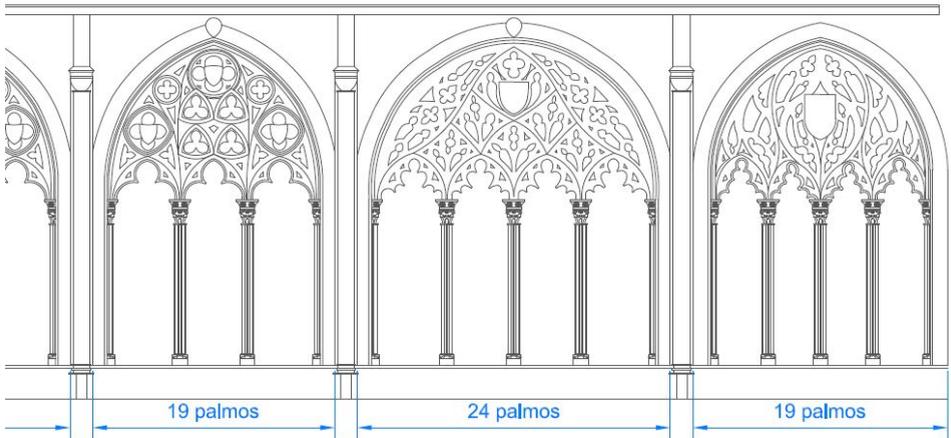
Detalle de Alzado Este acotado en palmos. 2016. Plano del autor.
